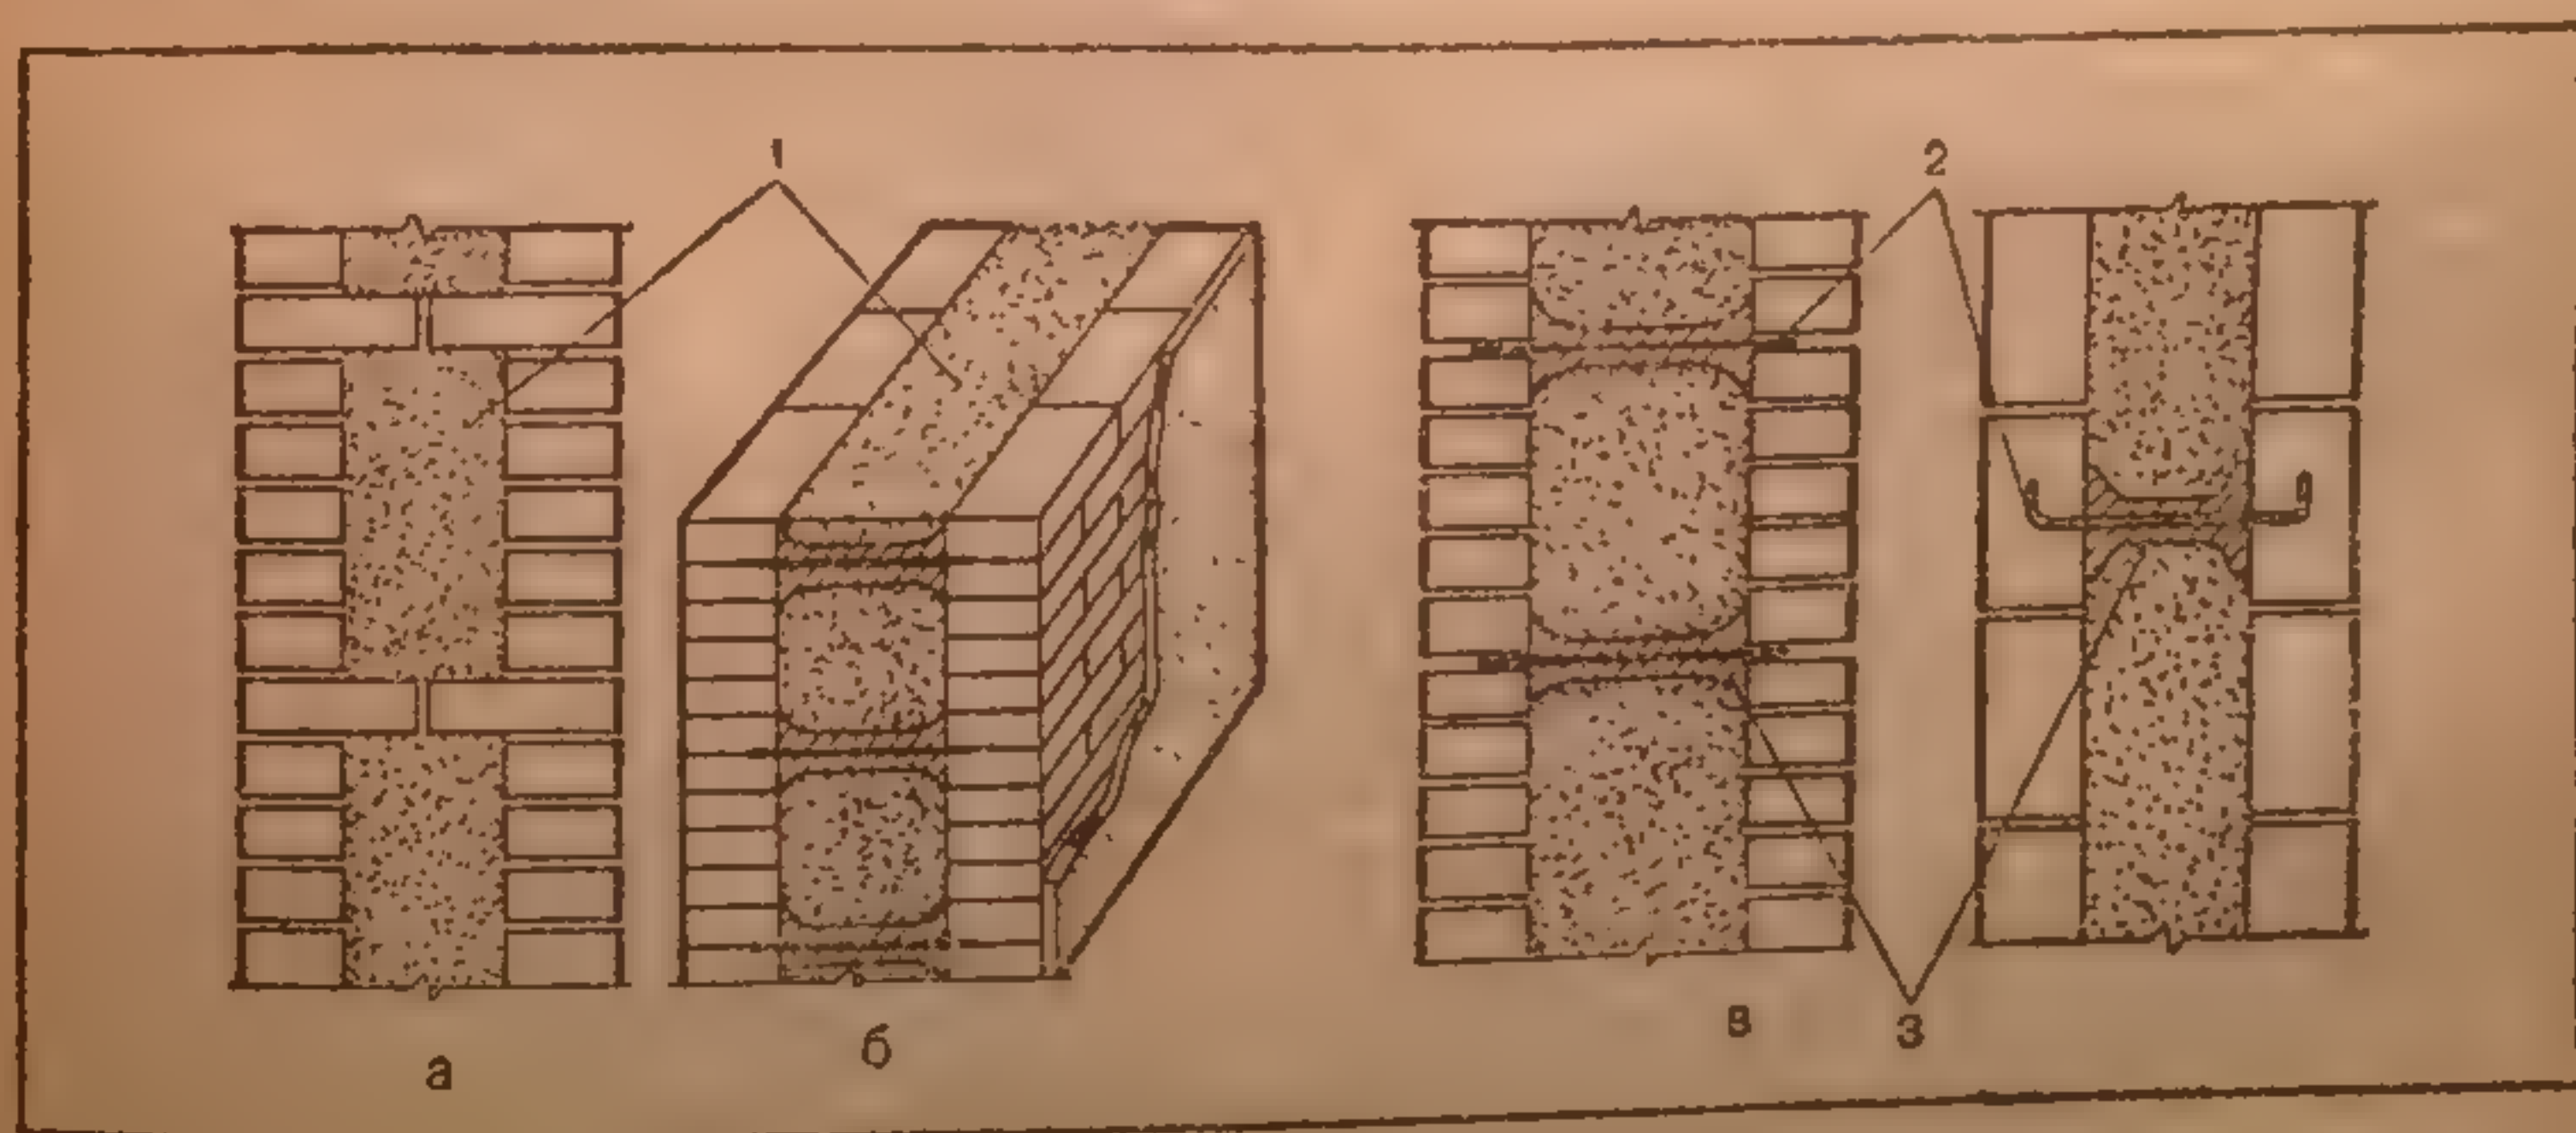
Облегченная кладка с горизонтальными диафрагмами: а — с кирпичными диафрагмами; б, в — с растворными диафрагмами, армированными стальной арматурой; 1 — засыпка или легкий бетон; 2 — арматурная сталь; 3 — раствор
